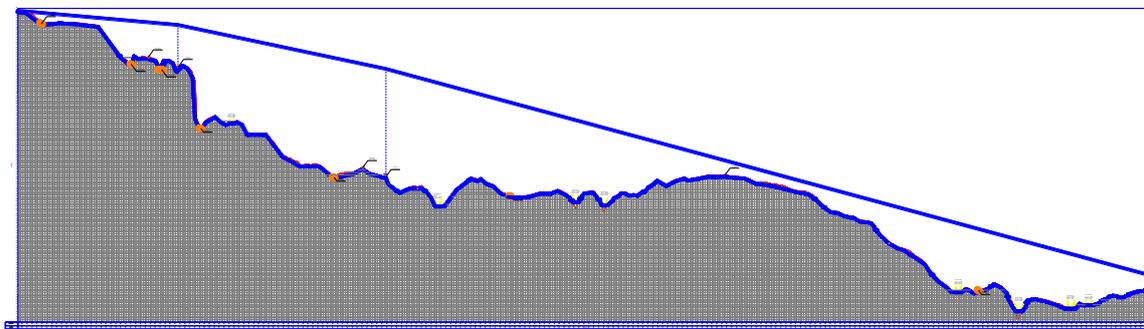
Perfil Longitudinal de la línea de conducción. (Elaboración: propia)
